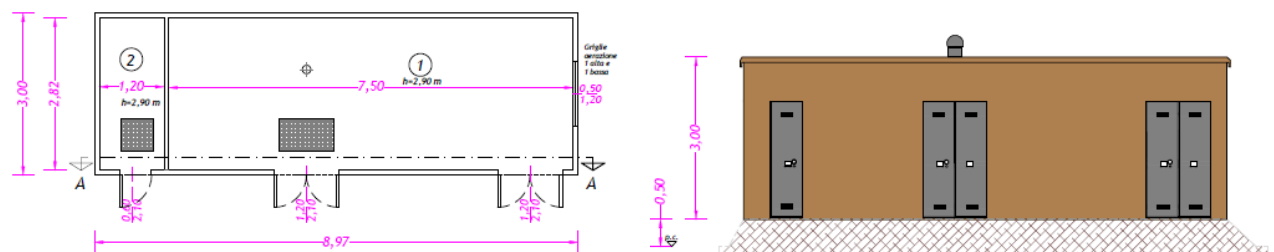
Pianta e profilo della cabina di consegna Bernardo FV
